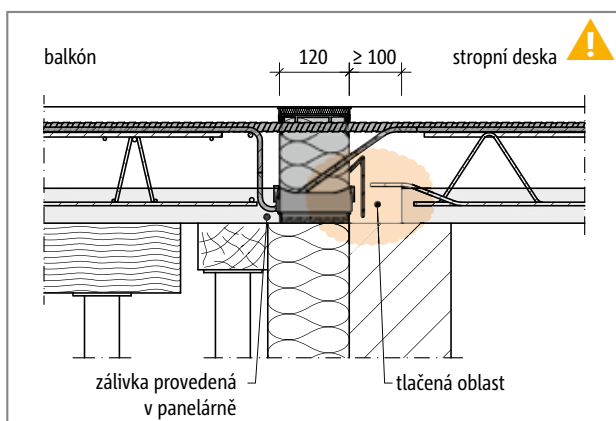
Schöck Isokorb® CXT typ KL: Prefabrikovaný balkón, jehož spodní hrana je snižena vůči stropní desce uložené na železobetonové stěně
